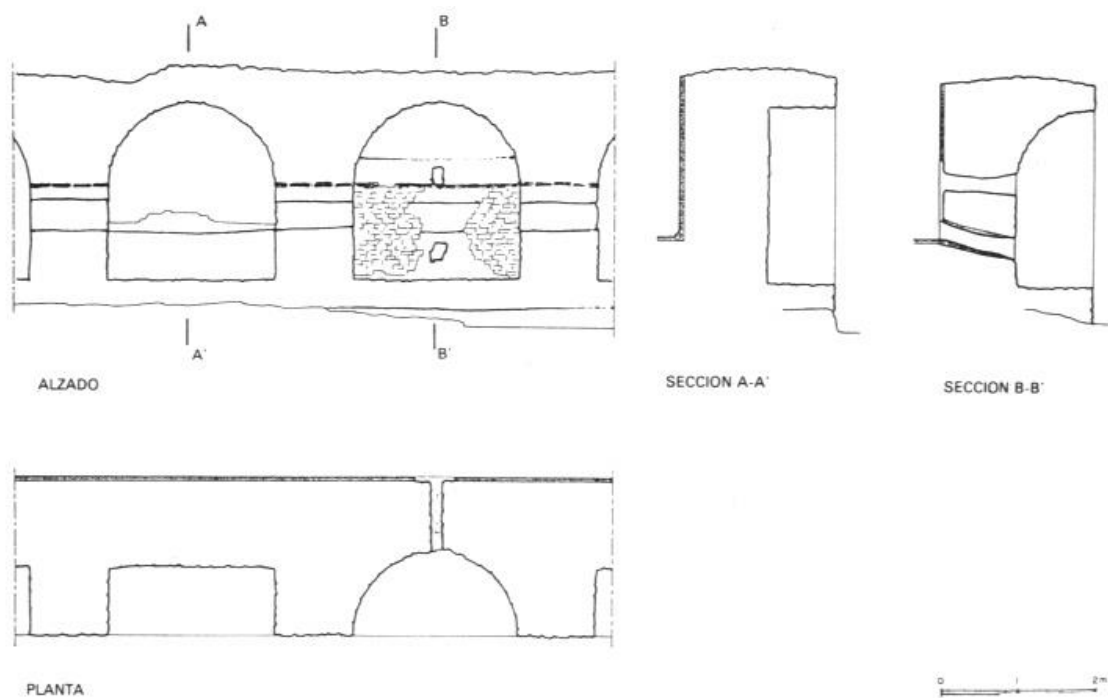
Planta, alzado y secciones del muro Este (RIÑONES, 1987: 253, fig. 2).
